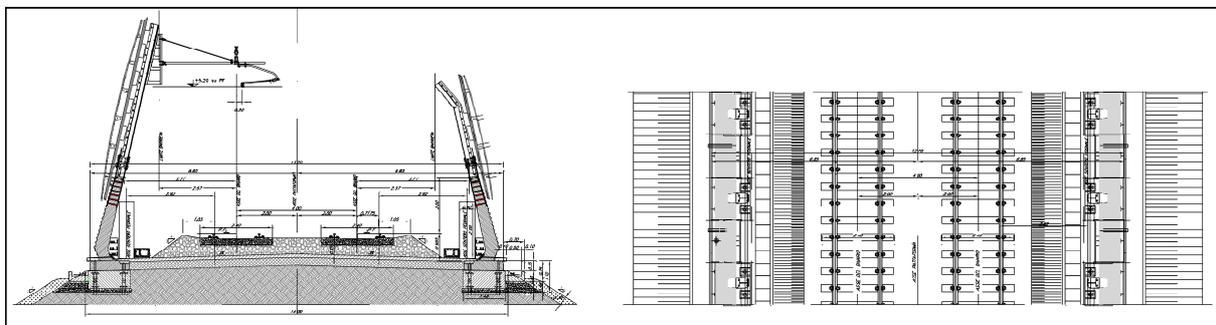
Sezione Tipo doppio binario in Rilevato – con Barriere Antirumore
